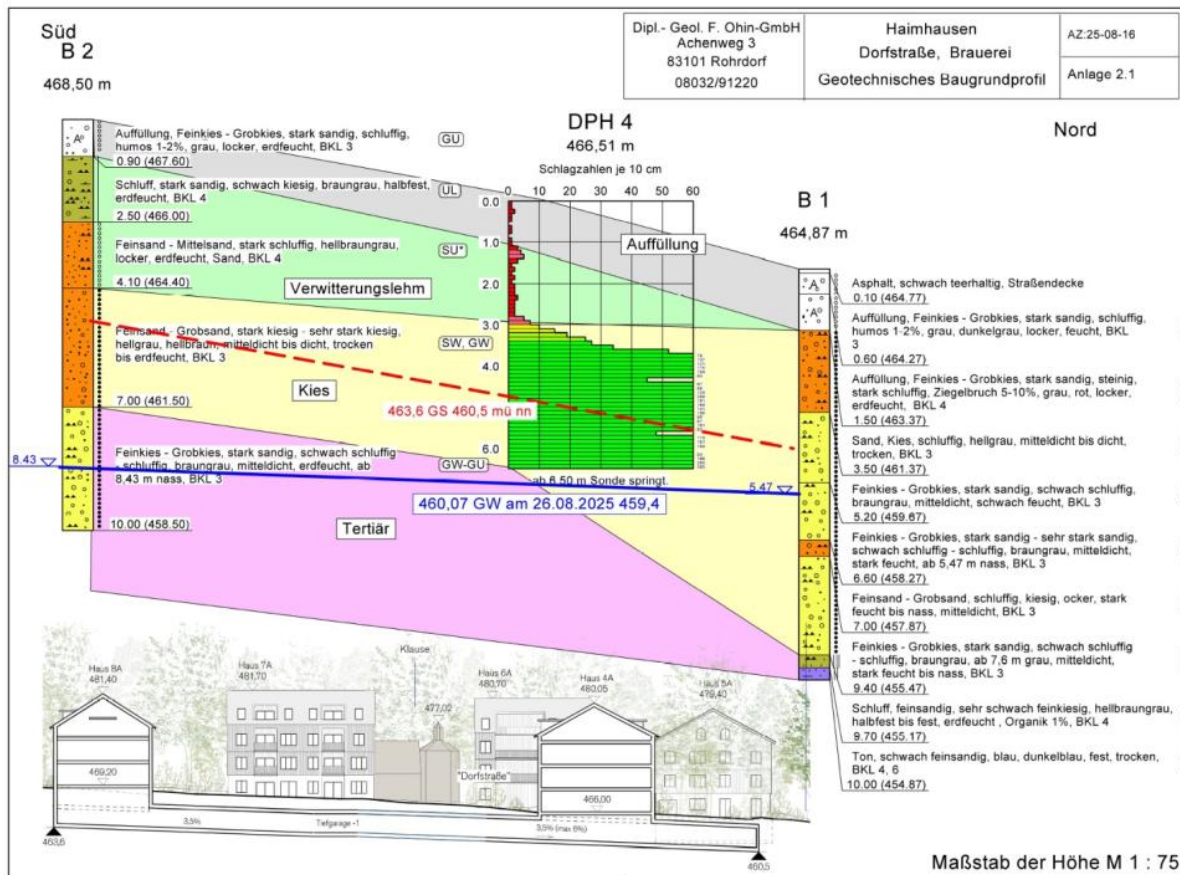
Baugrundprofil mit Gründungssohle und Grundwasserstand – ohne Maßstab
